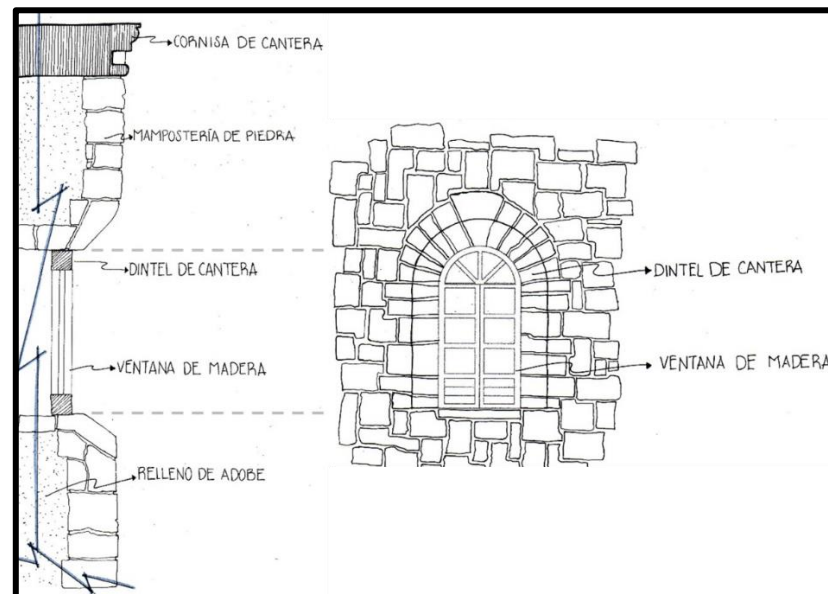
Corte por fachada de la Parroquia de San Bernardino. (Espinosa M. 2018)
